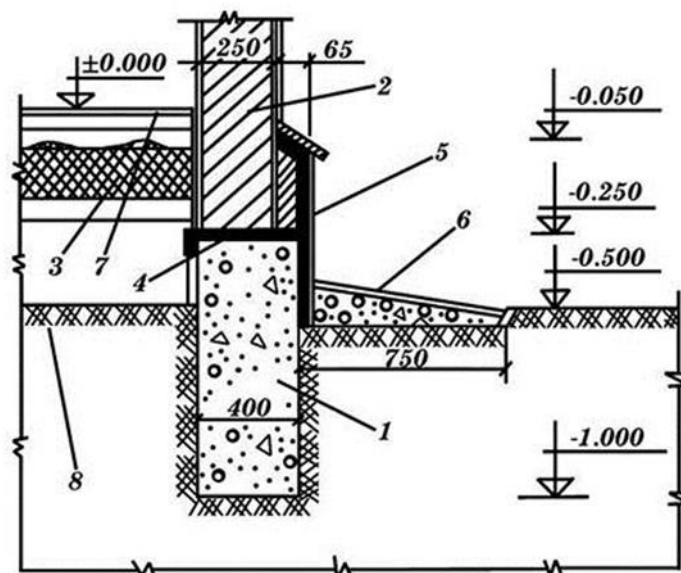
Конструктивний вузол стрічкового фундаменту з монолітного бетону: 1 - фундамент з монолітного бетону марки 100 (ширина – 40 см, висота – 75 см, глибина закладення в ґрунт основи – 50 см); 2 – стіна; 3 – утеплювач; 4 – гідроізоляція; 5 – цоколь; 6 – відмостка; 7 – покриття підлоги; 8 – ґрунт.
